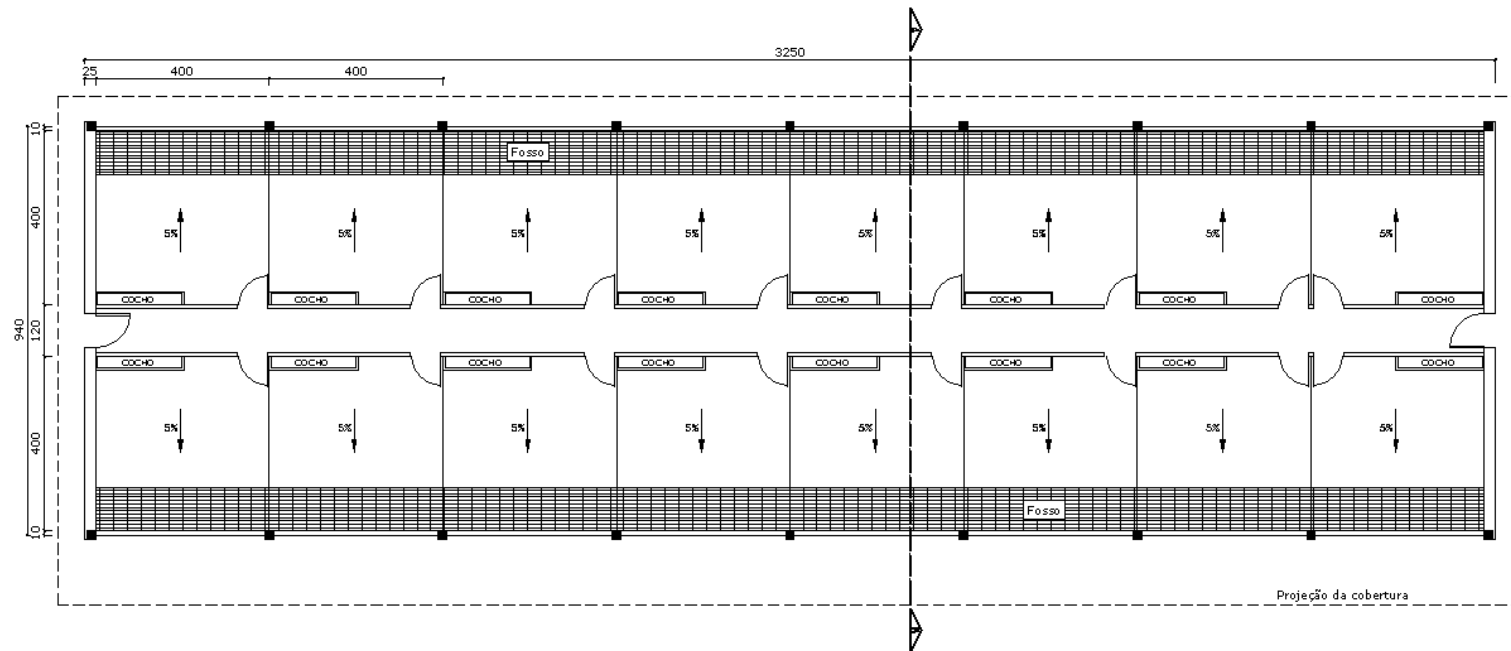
Planta baixa do galpão de crescimento e acabamento.
